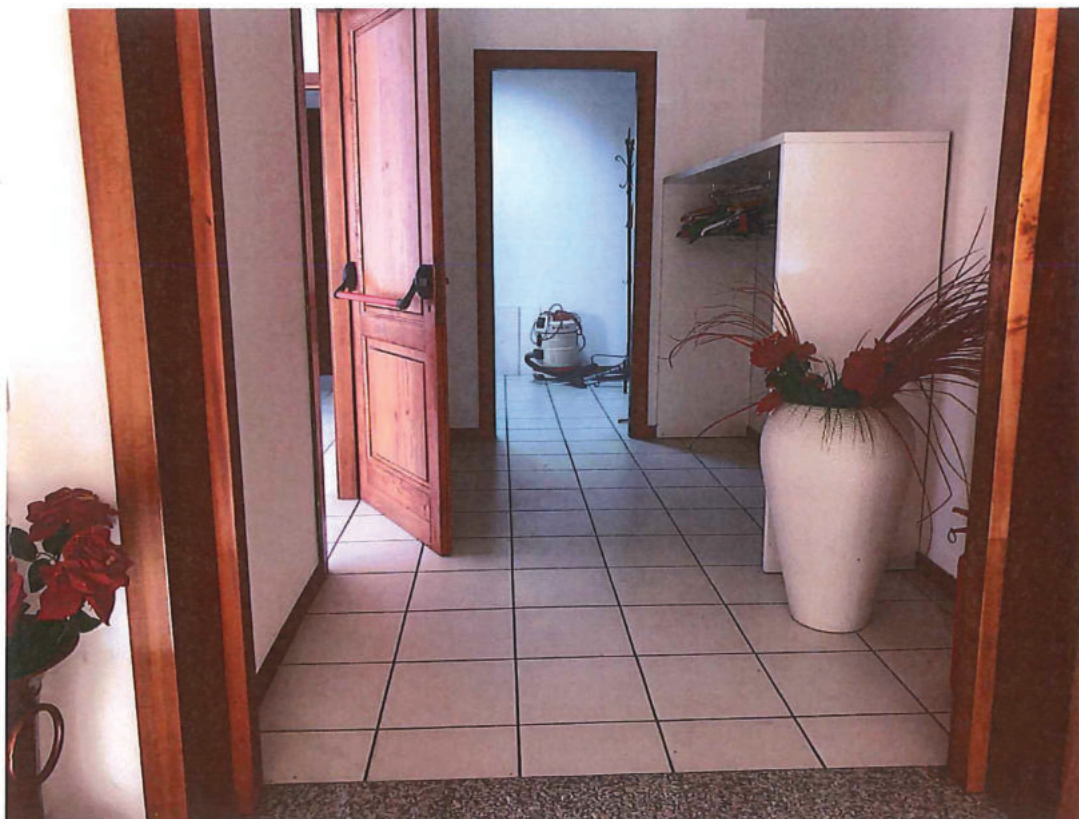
Piano primo. Foto scattata dal vano scale (vd. stacco pavimentazione) verso la zona di ingresso al piano.
